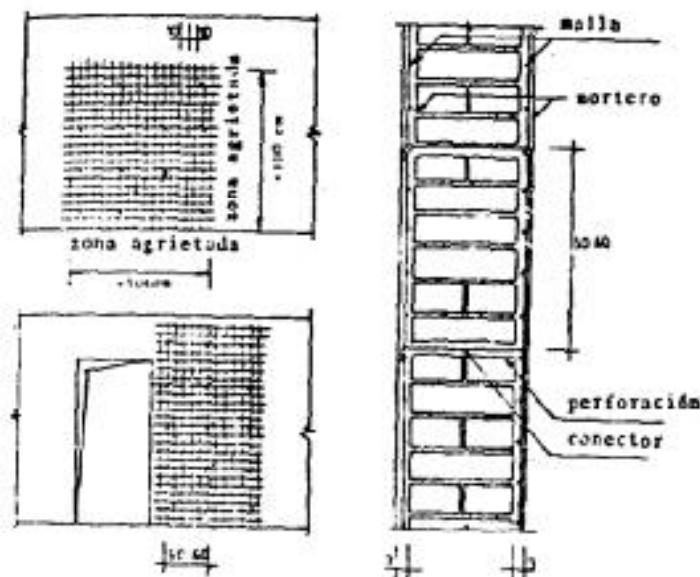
Recubrimiento de muros de mampostería con mortero reforzado (ref. 1)
